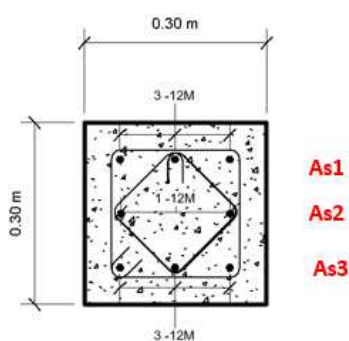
Armado de refuerzo de la columna (OMF) del sistema de 3 y 6 Pisos
